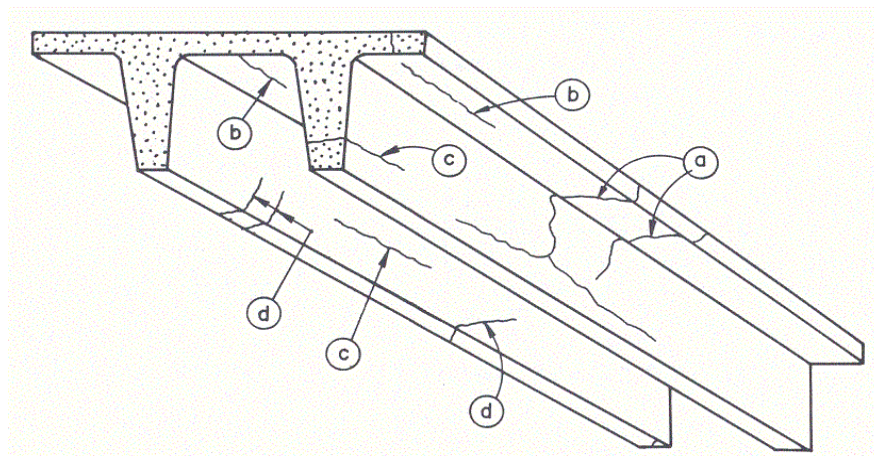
Patrón de Fisuras Causadas por la corrosión del acero de refuerzo en una viga.
